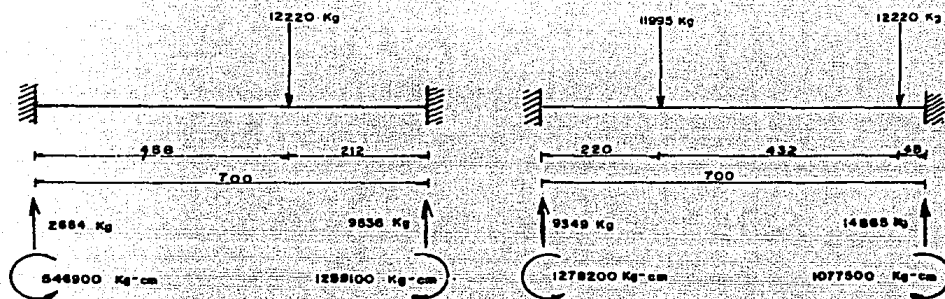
PREDISEÑO DE TRABES LONGITUDINALES EN ELEV. + 110.600
